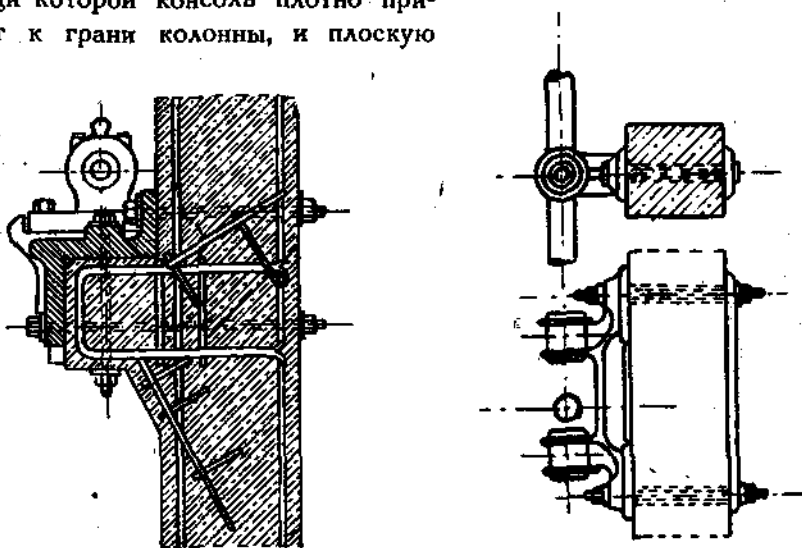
Укрепление рельса подвесной дороги к железобетонному перекрытию.
